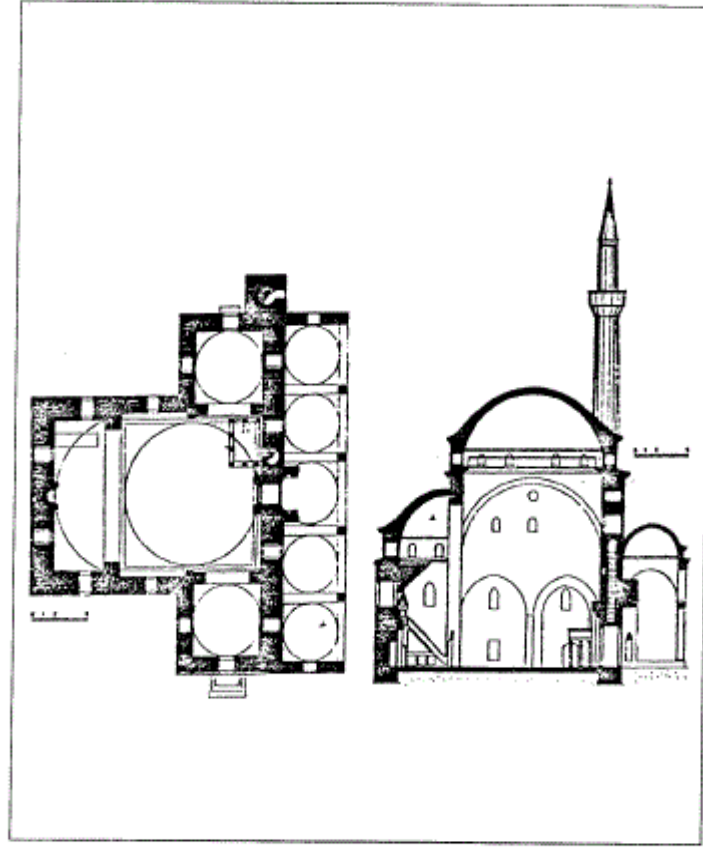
مسقط أفقي لمسجد بايزيد يلدريم أو مسجد خداونگار في أدرنة (عن
